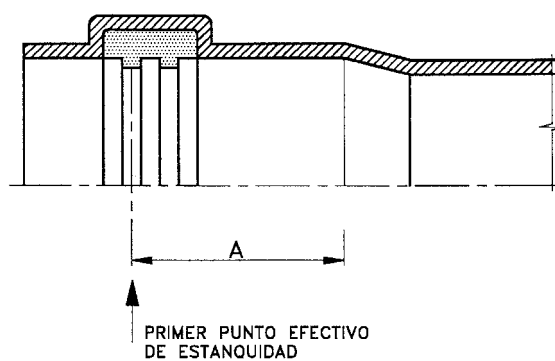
Primer punto efectivo de cierre. Juntas elásticas con múltiples zonas de estanquidad.
